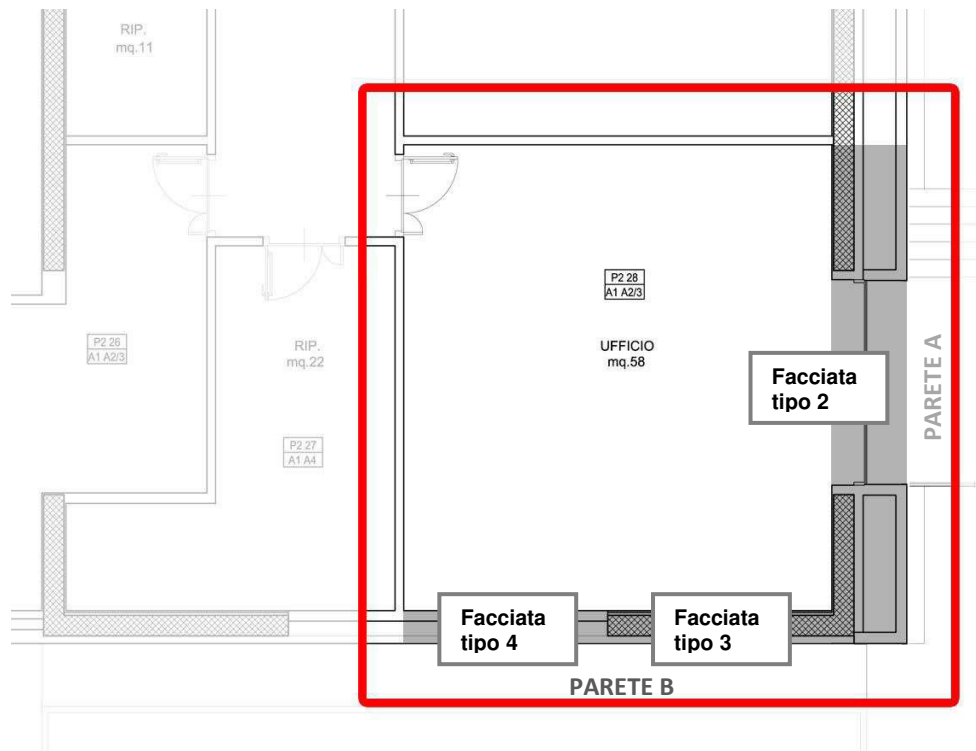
Dettaglio pianta secondo piano con individuazione delle pareti di facciata.
